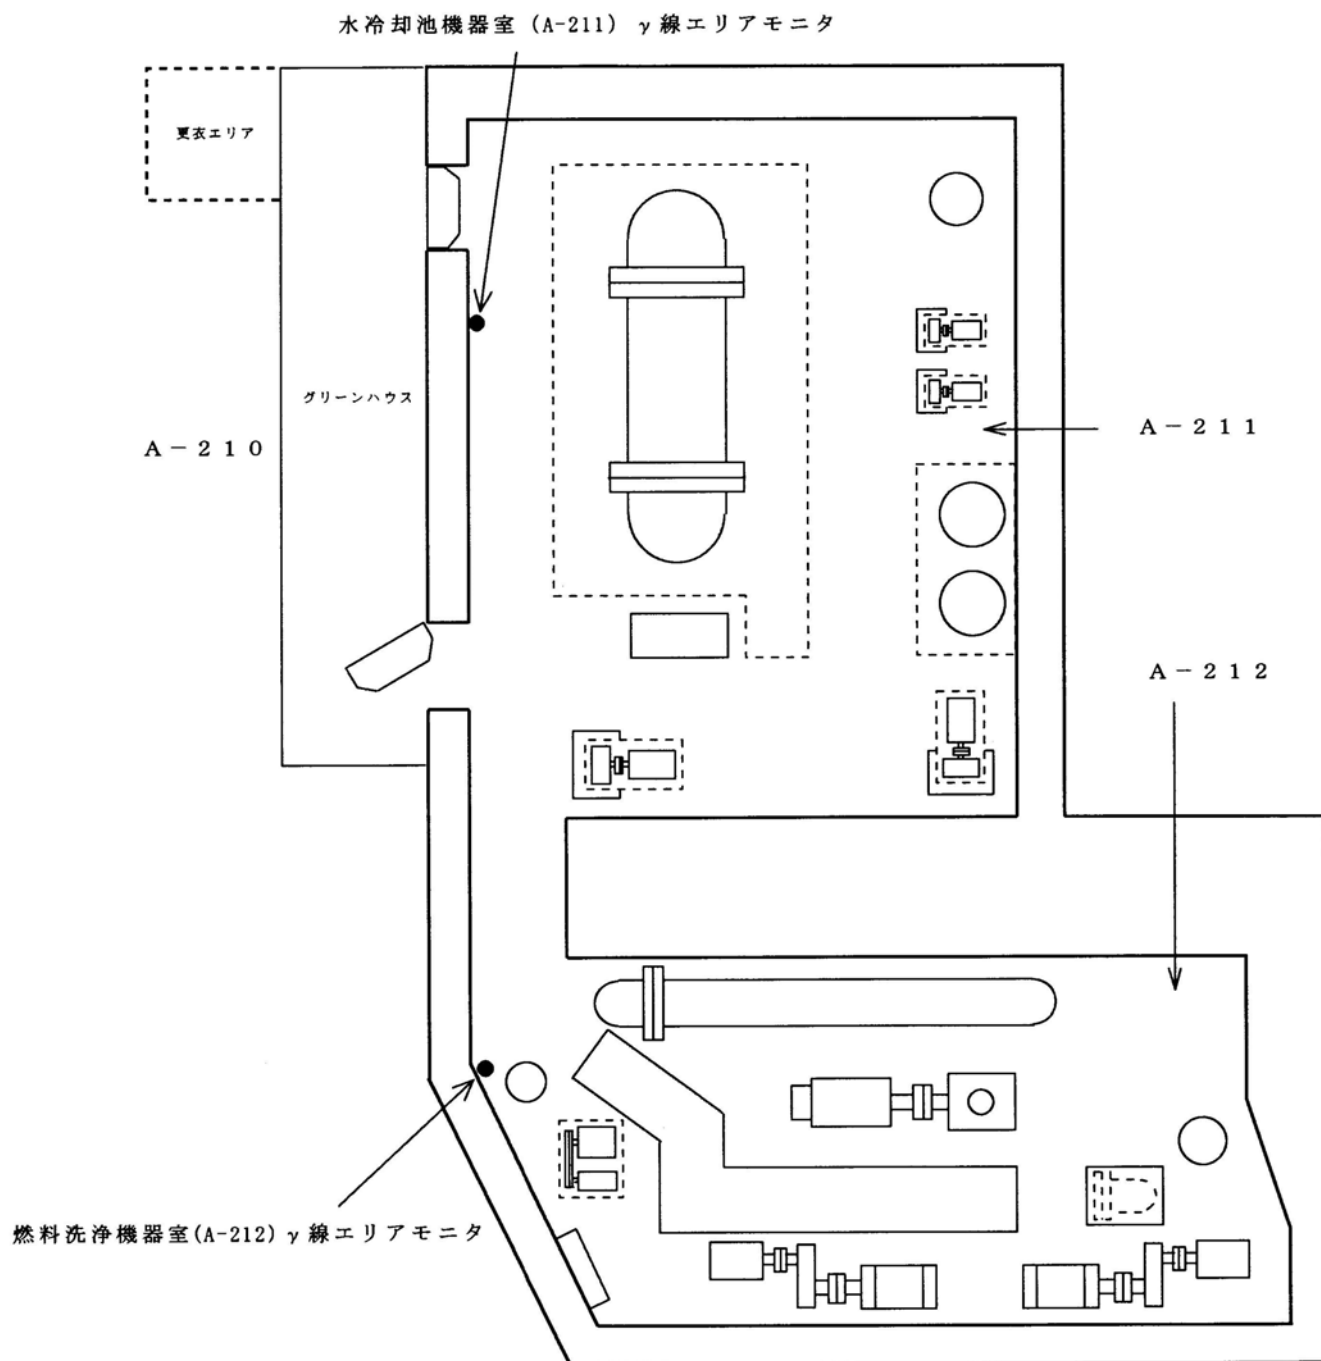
原子炉付属建家 A-211・A-212 γ 線エリアモニタ配置図
